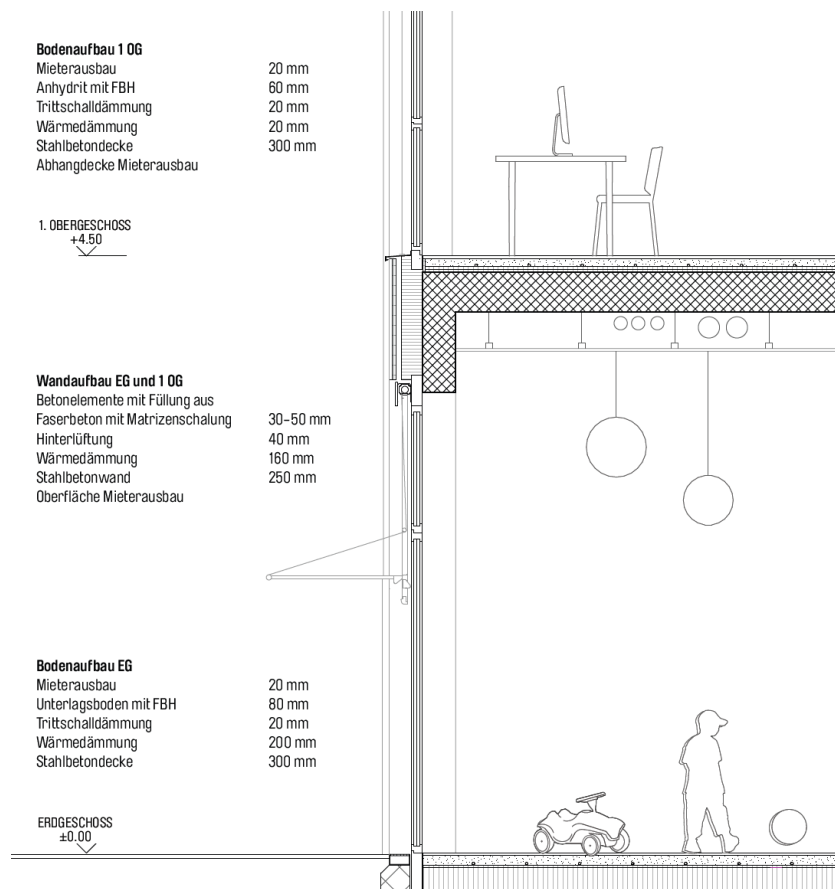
Ausschnitt Detailschnitt Strassenfassade
